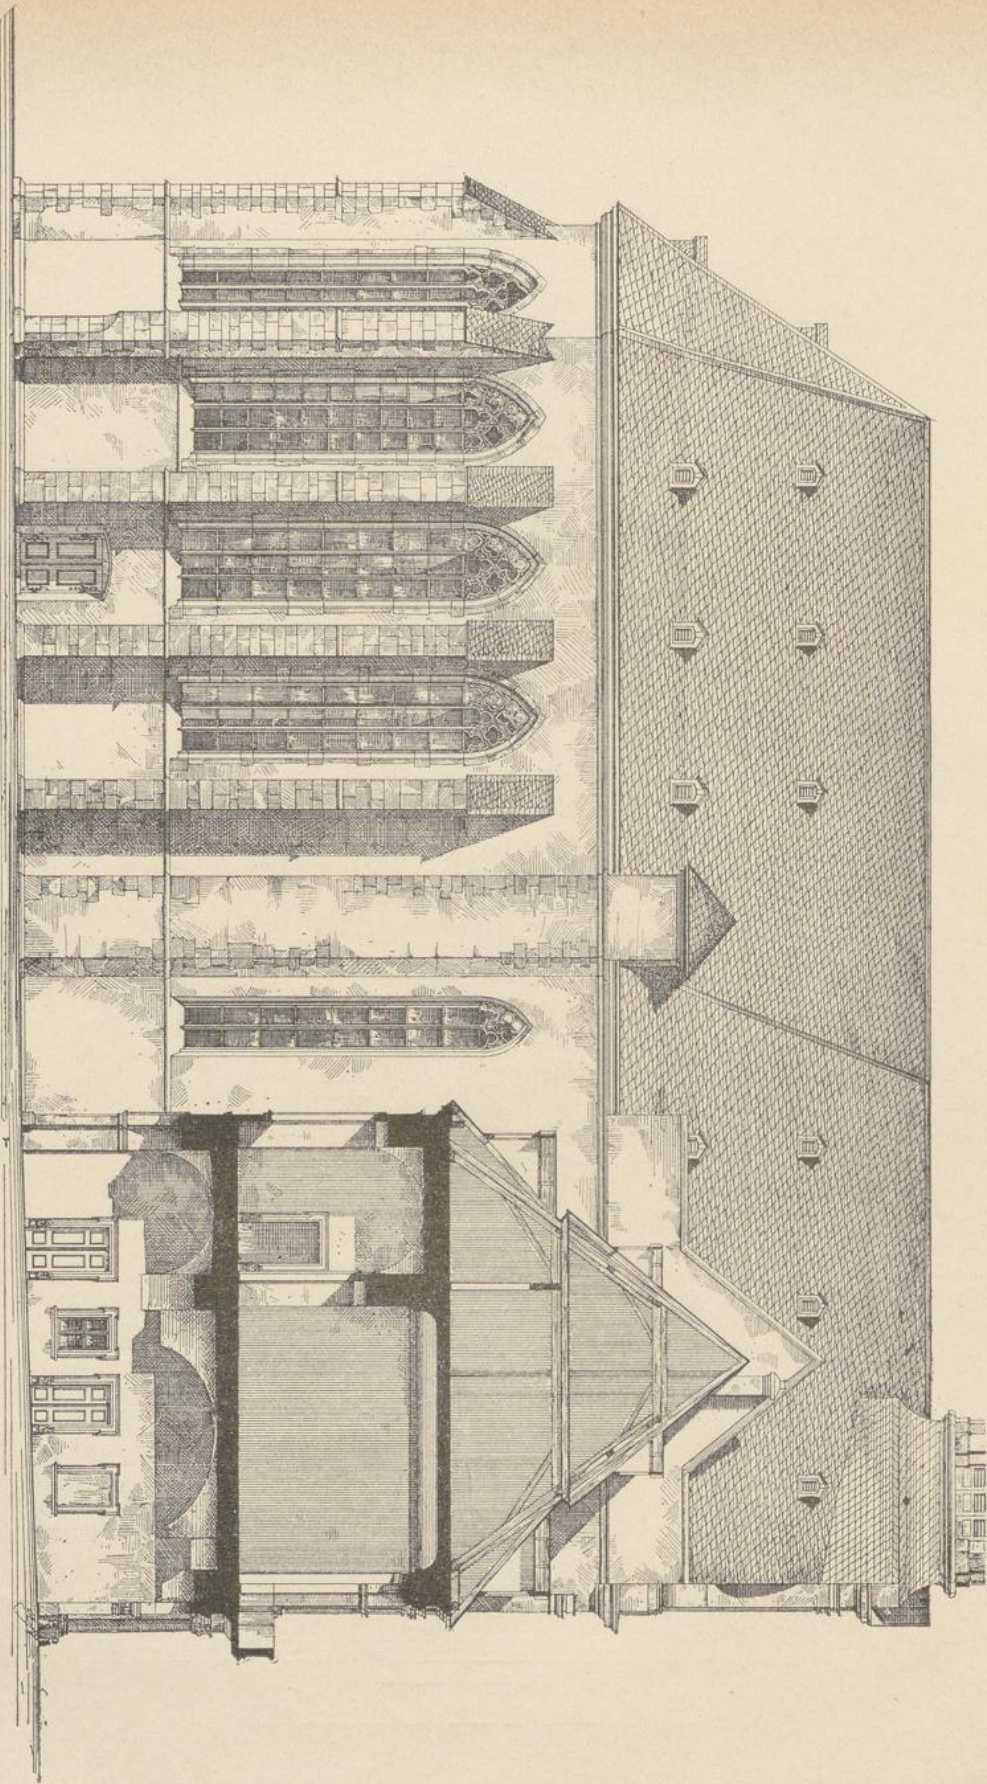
Nordseite der Kirche und Querschnitt des Hauses.
